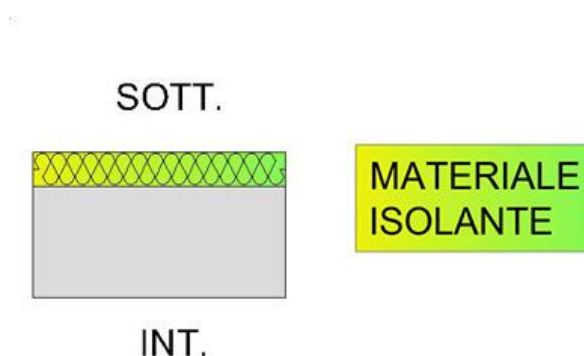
schema di isolamento del solaio di sottotetto dall'estradosso (Fonte ANIT)
